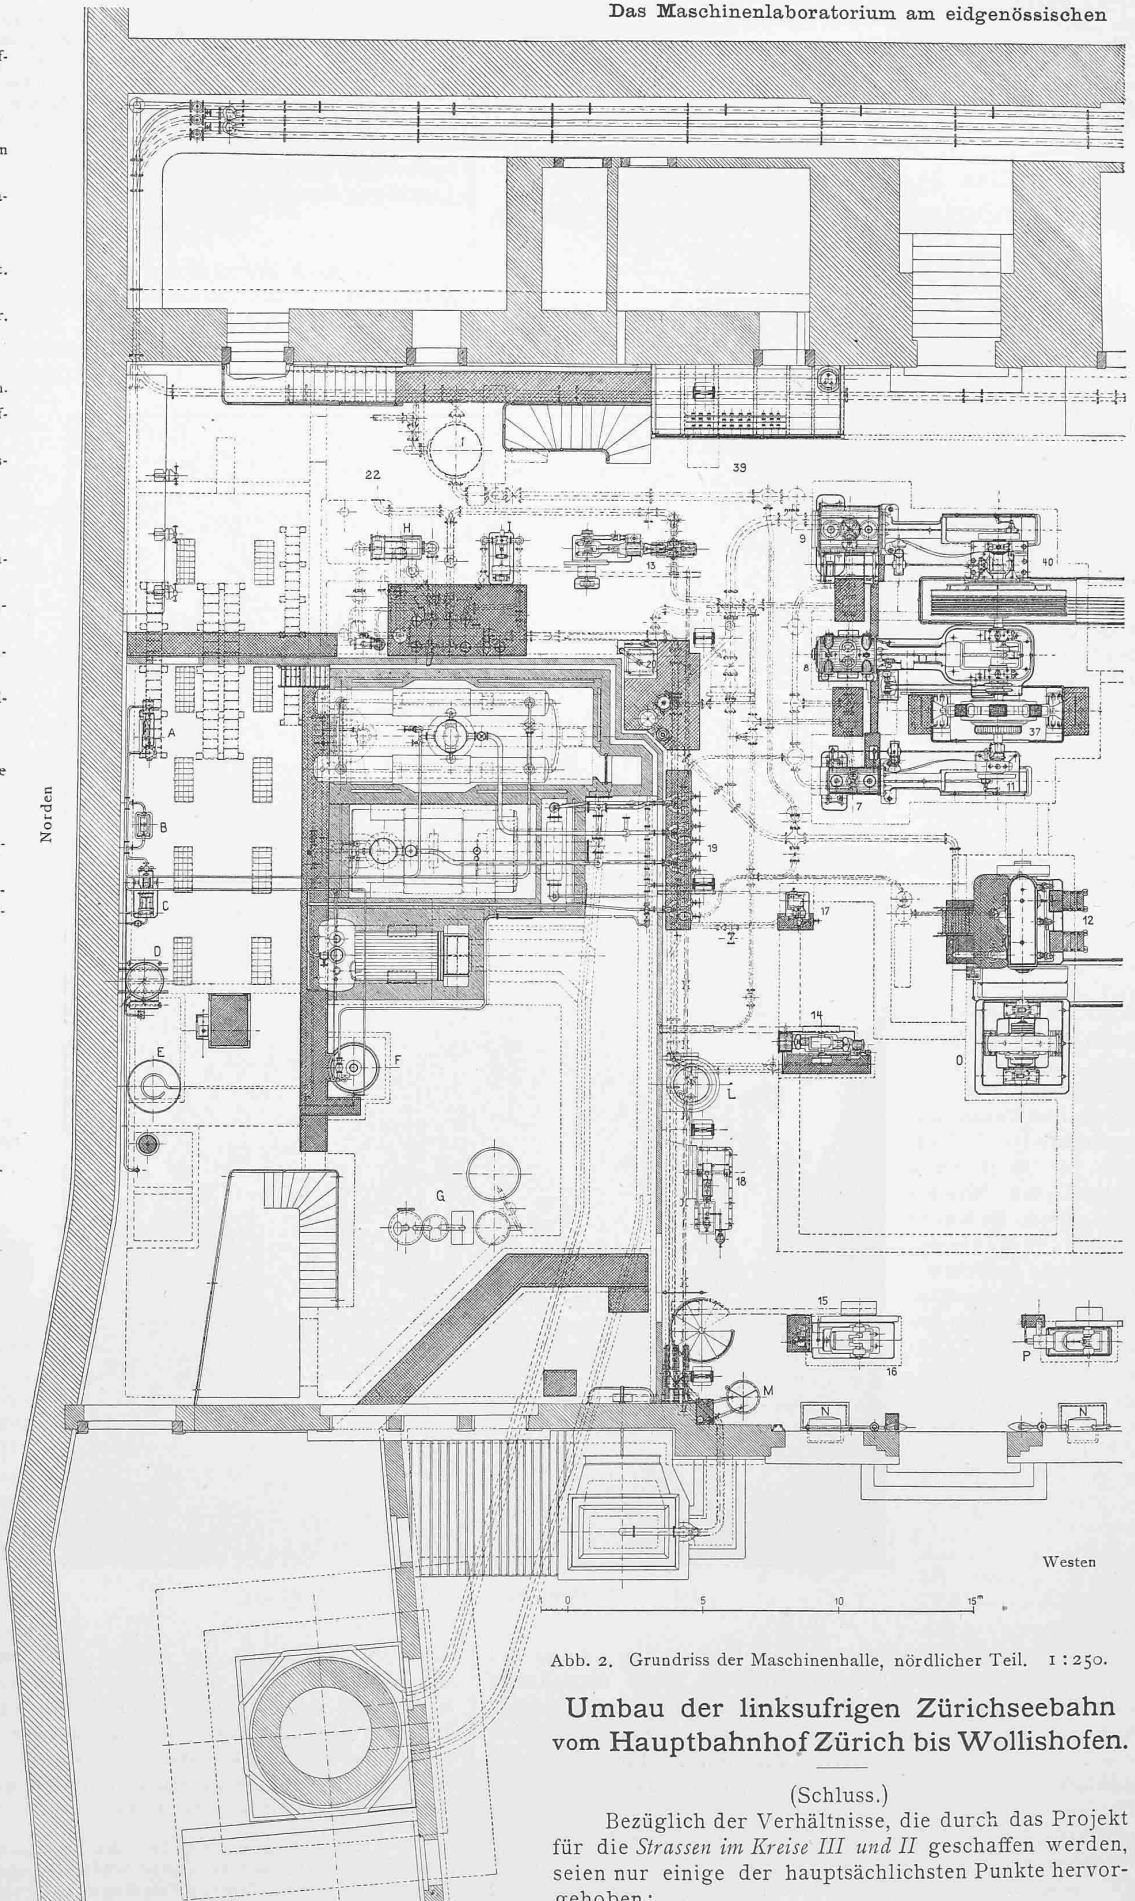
Grundriss der Maschinenhalle, nördlicher Teil. 1 : 250.
